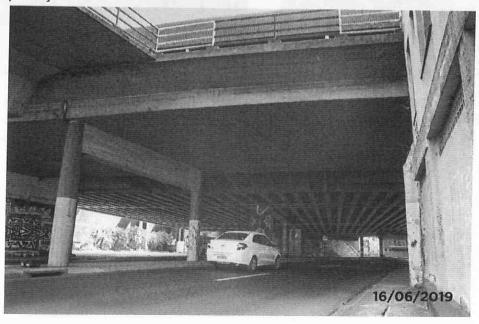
Vista da face inferior do tabuleiro com presença de infiltração, eflorescência, desplacamento de concreto
